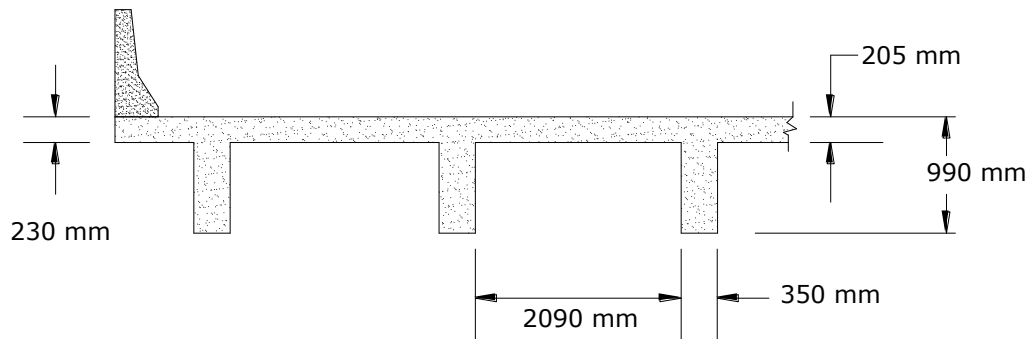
Dimensiones de prueba para el Puente Viga T
